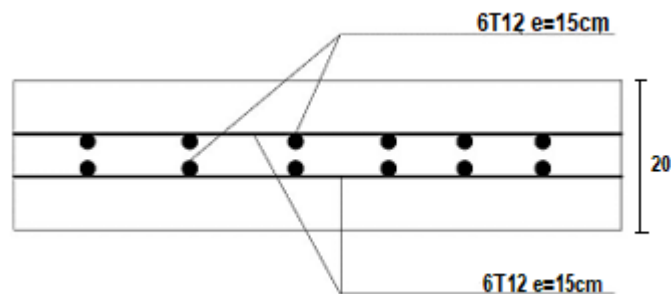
Dessin de ferrailage de la dalle pour 1ml.
